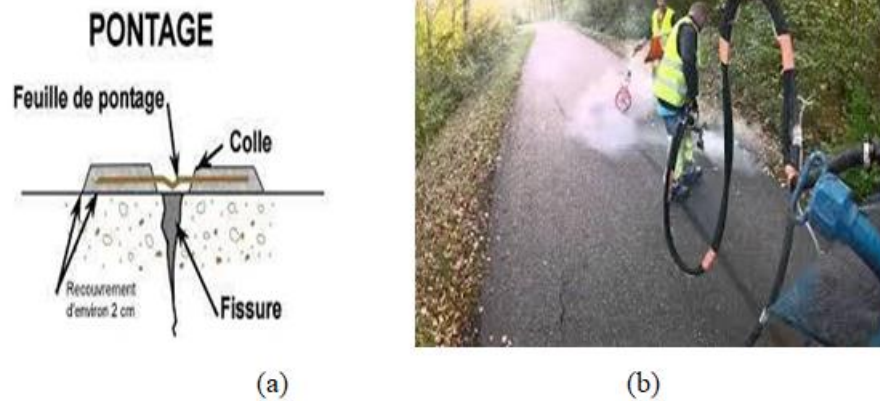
(a)traitement d'une fissure, (b) pontage d'une fissure
